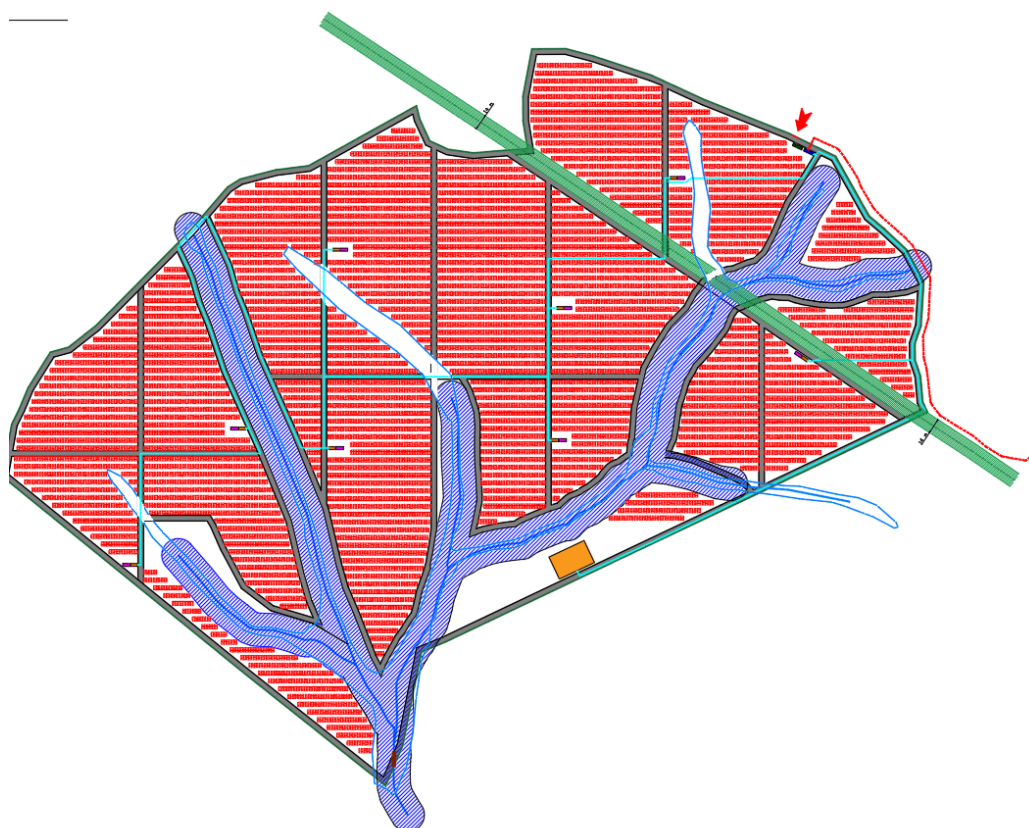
Layout impianto – fasce di rispetto dei fossi
